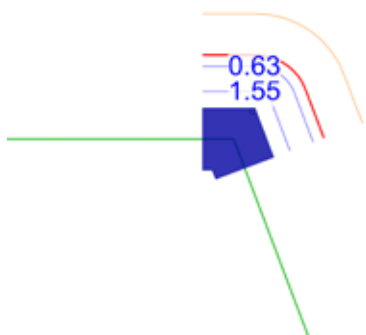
Erforderliche Durchstanzbewehrung je Rundschnitt an Wandecke
